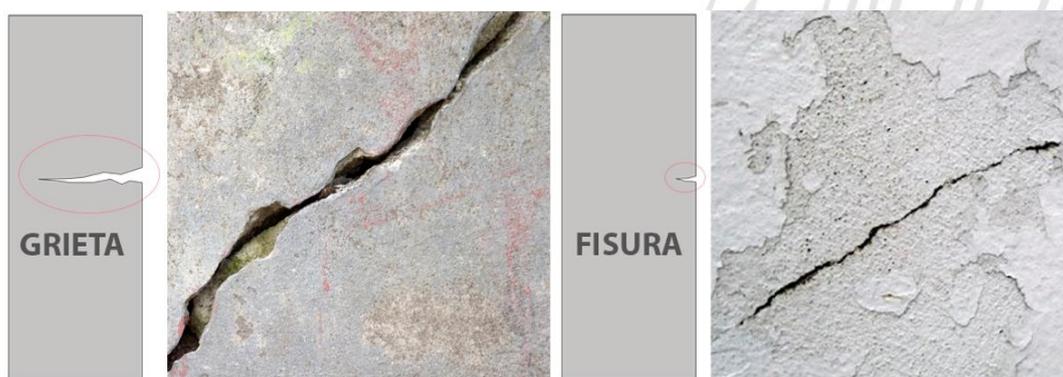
Diferencia entre grieta y fisura. Modificado de: (Blog Paqsa, n.d.; Grietaspared.com, 2017)
